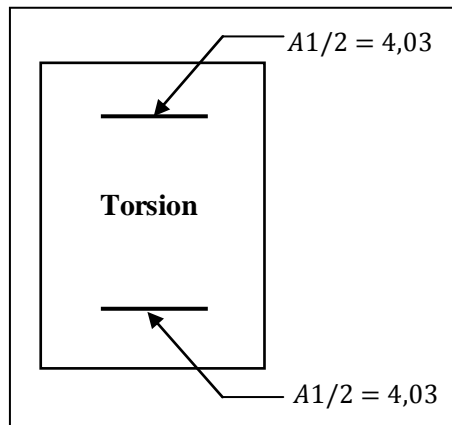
Section d'armatures de la poutre palière calculée à la torsion
